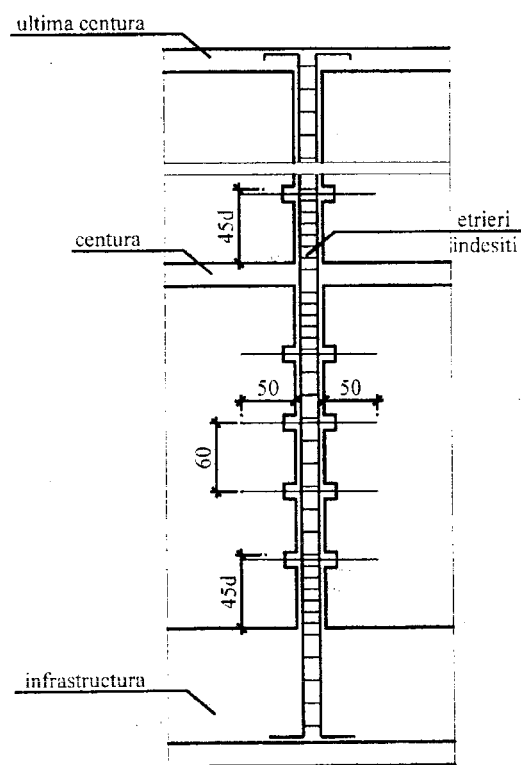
Solidarizarea stâlpișorilor cu zidăria – elevație
